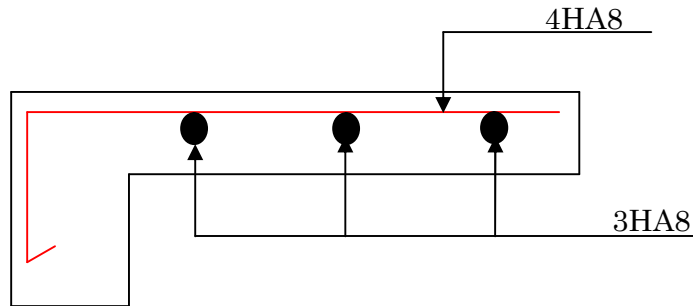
Ferrailage de la dalle sur trois appuis
